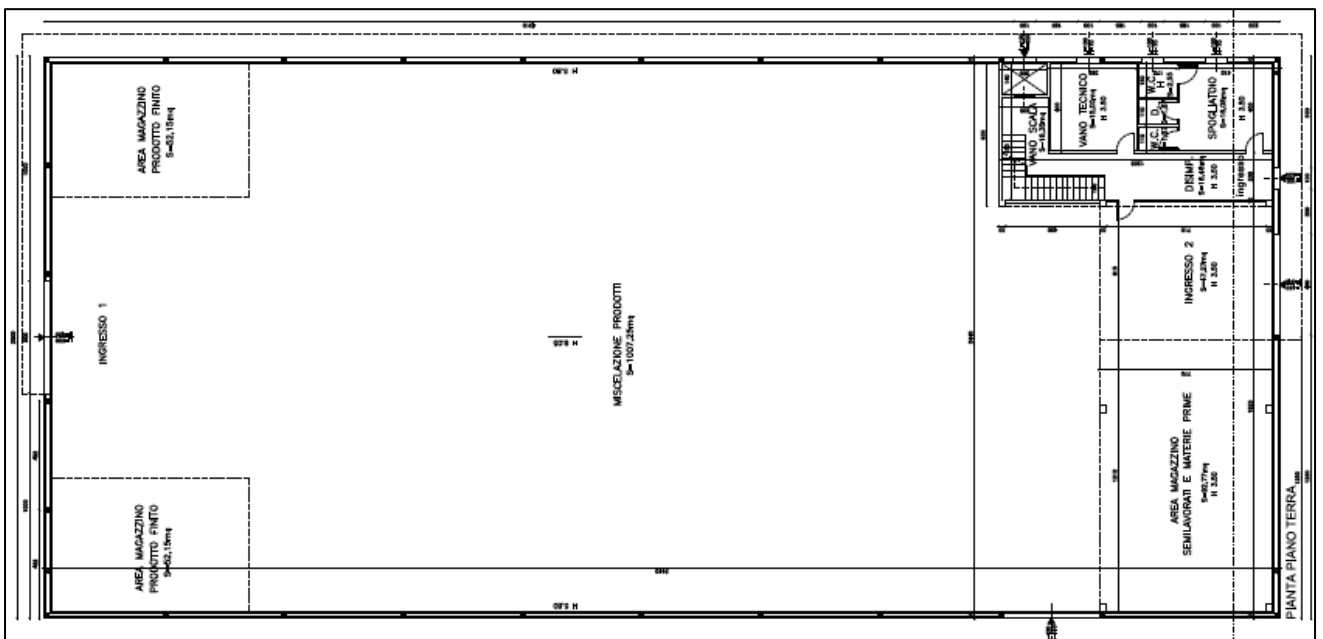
Planimetria stato di progetto Piano Terra (estratto tavola n.6 – progetto piante)
